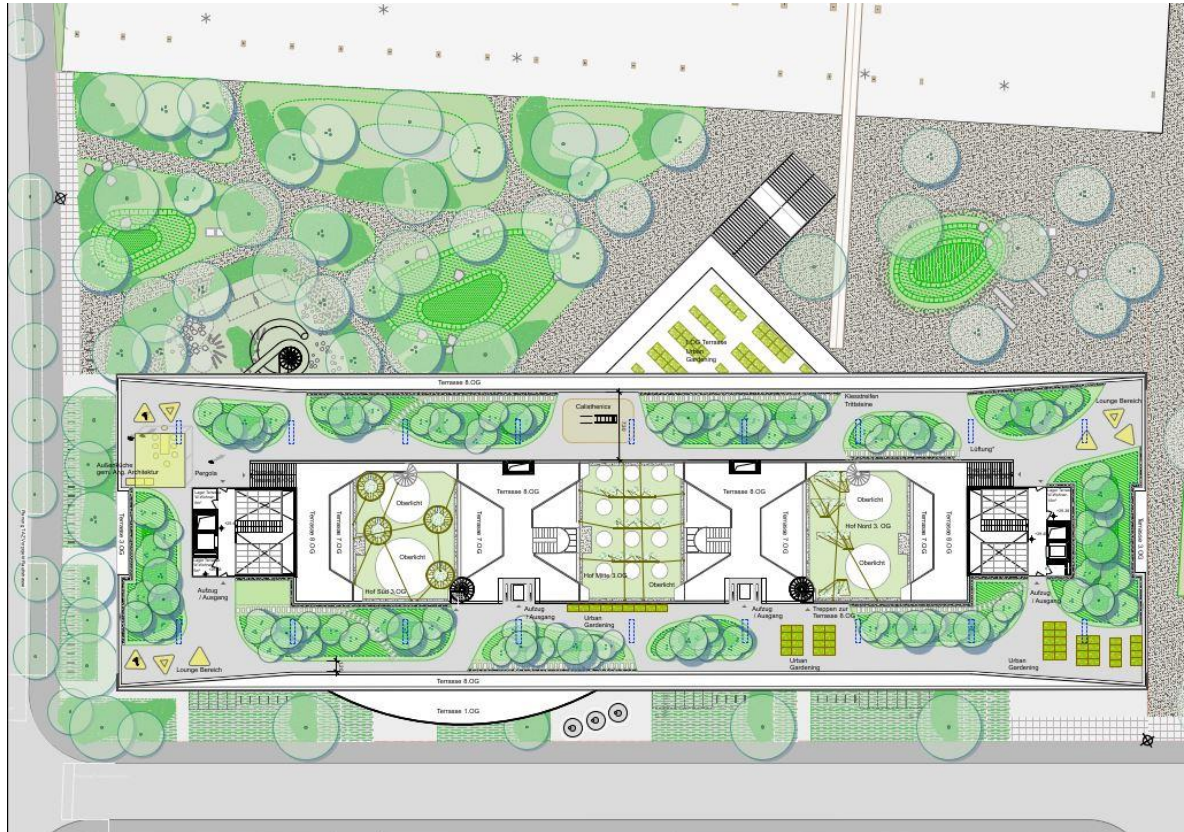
Dachaufsicht mit Umgebung, Studio Trachsler Hoffmann, Atelier Loidl, April 2020
